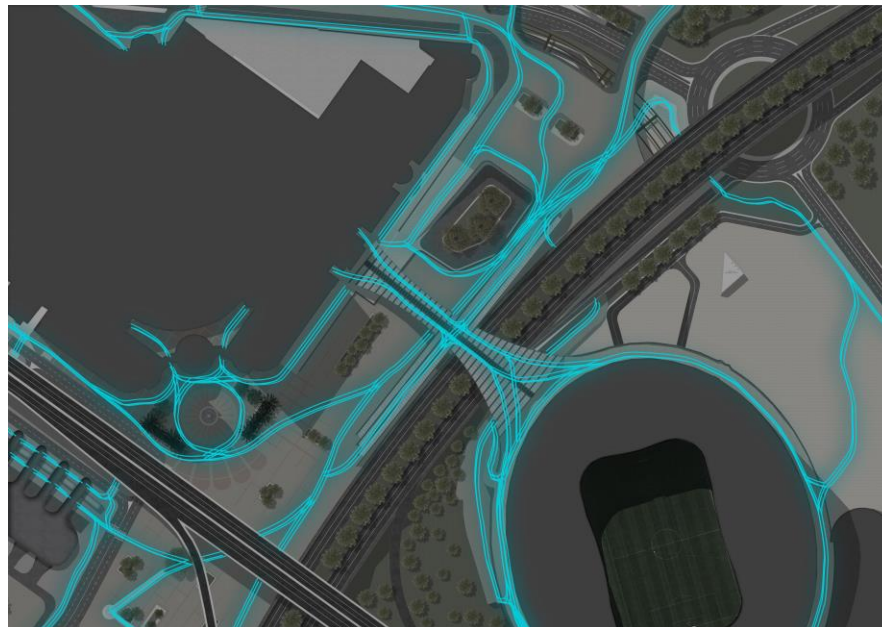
Canais de circulação pedonal proposto após intervenção na Zona E
